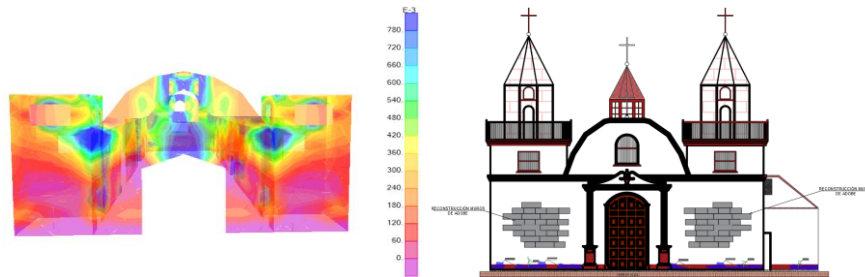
Grietas formadas a causa de esfuerzos a flexión en muro frontal.
